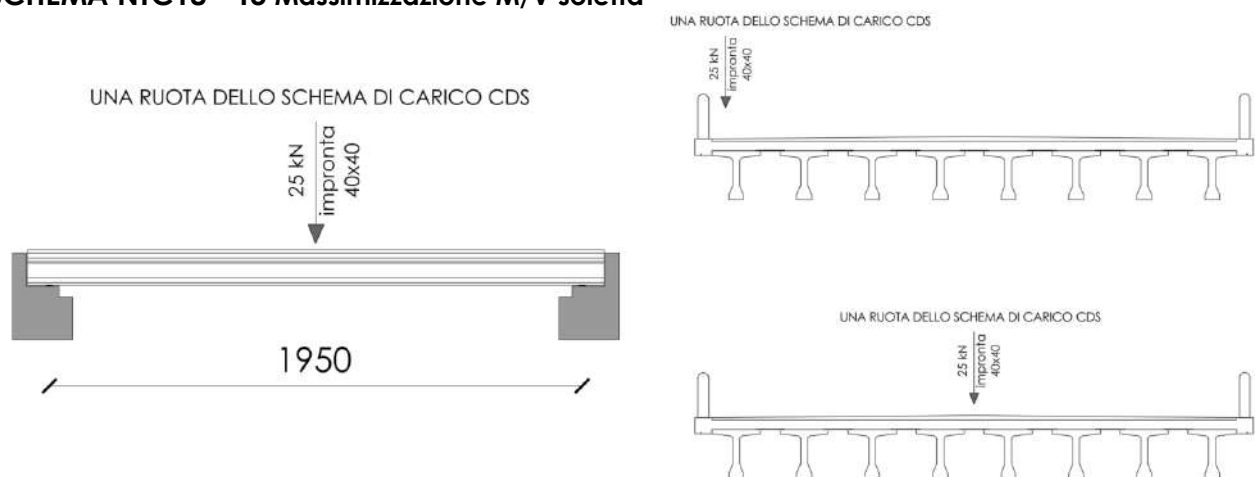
SEZIONE LONGITUDINALE (SX) E SEZIONI TRASVERSALI CAMPATA (DX)
